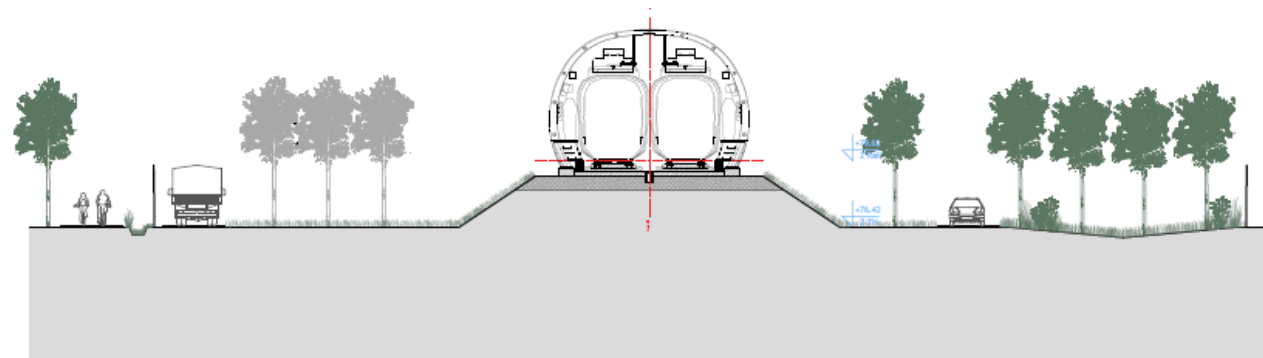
Coupe type de l'ouvrage en terre de Tremblay-en-France
